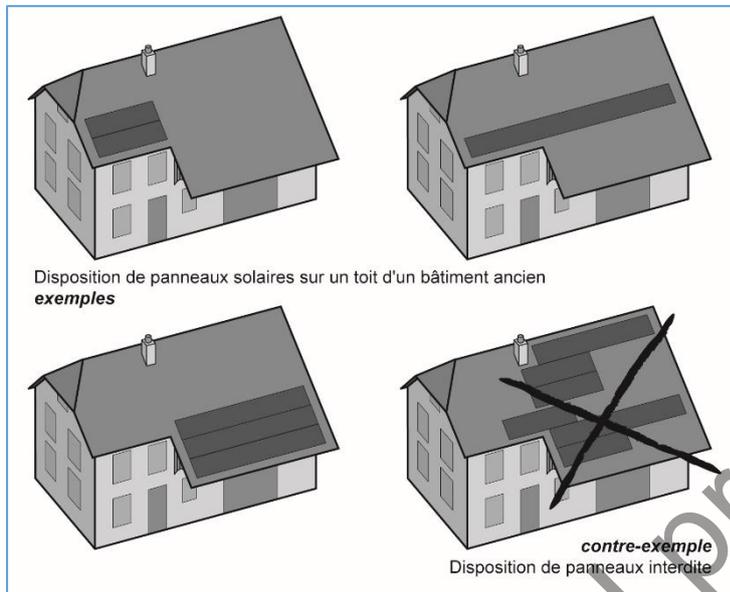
Schéma de positionnement de panneaux solaires sur un bâti ancien.
